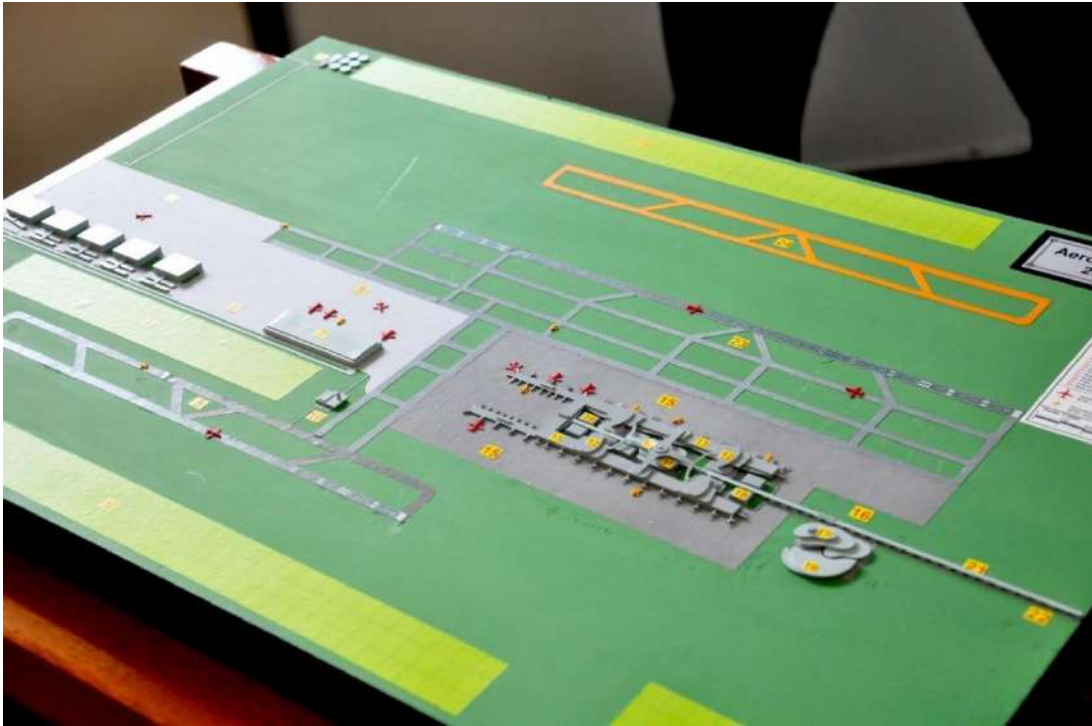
Croquis Preliminar do Plano Diretor do Aeroporto
